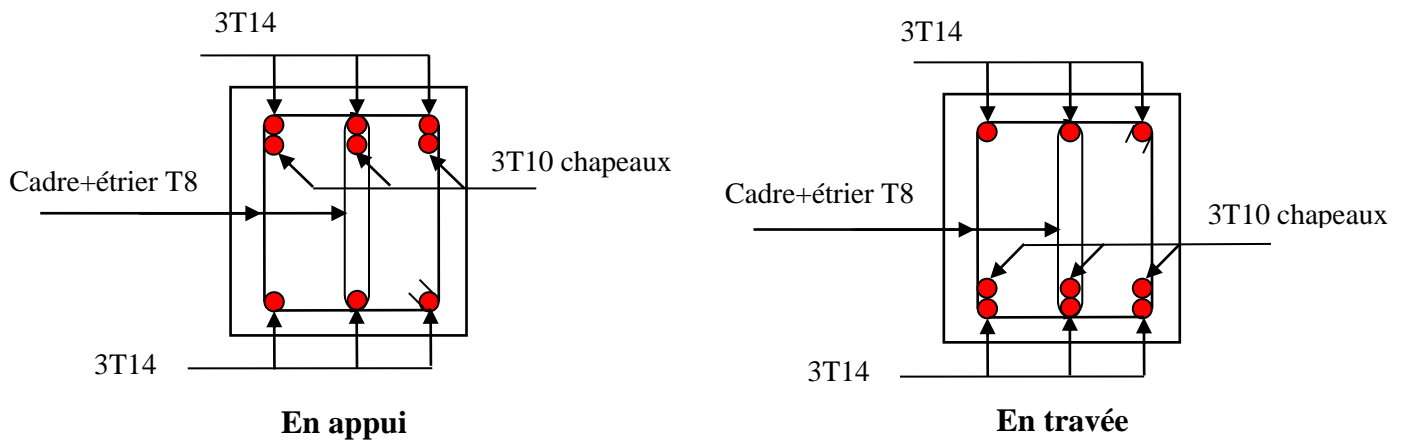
Schémas de ferrailage des poutres secondaires RDC
